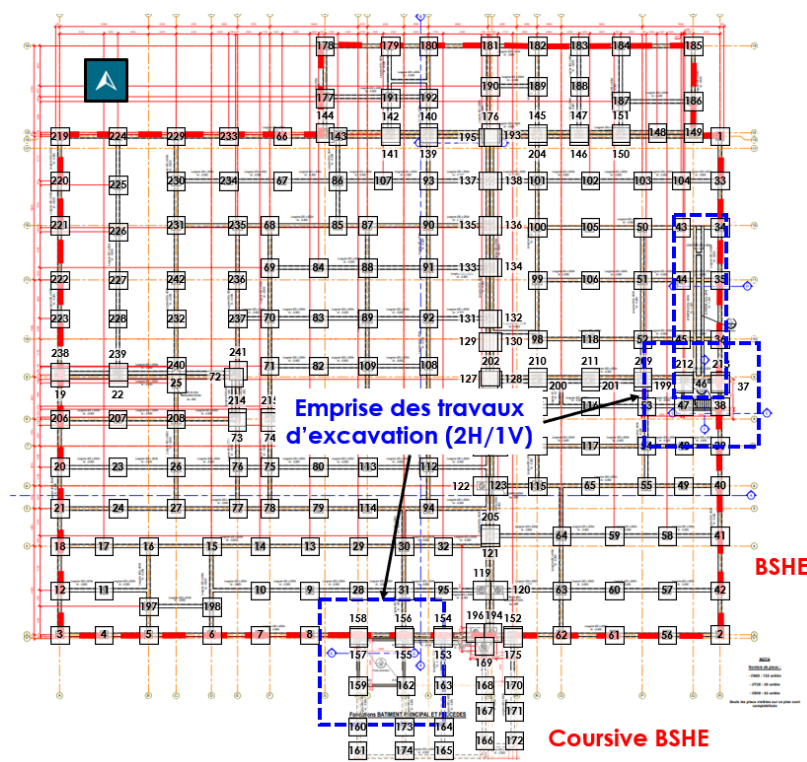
Zone d'emprise des travaux d'excavation – GEOTEC – Sans Echelle
